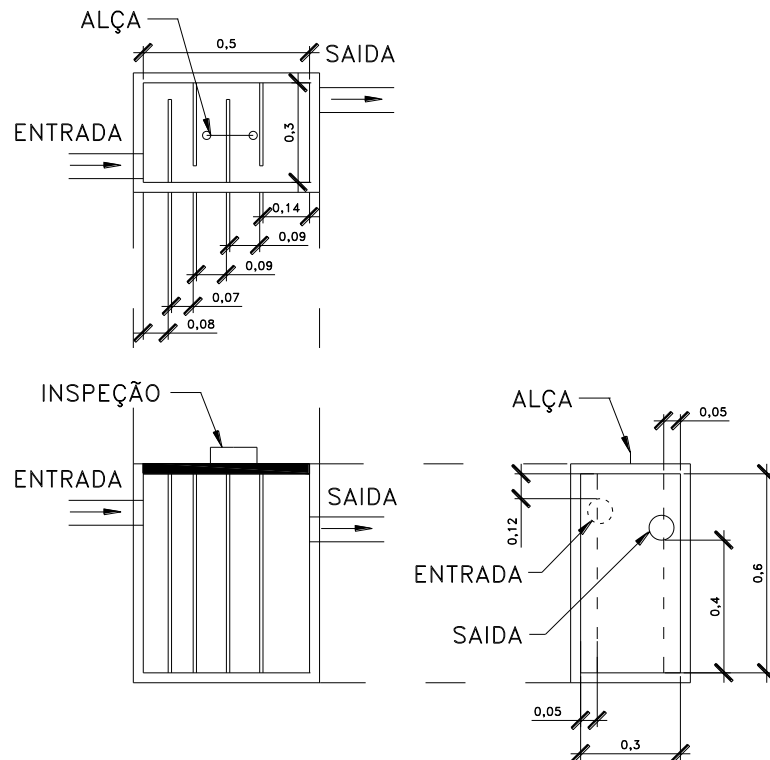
Desenho esquemático da decantador de fluxo horizontal (mistura lenta) em planta, perfil e corte lateral.
